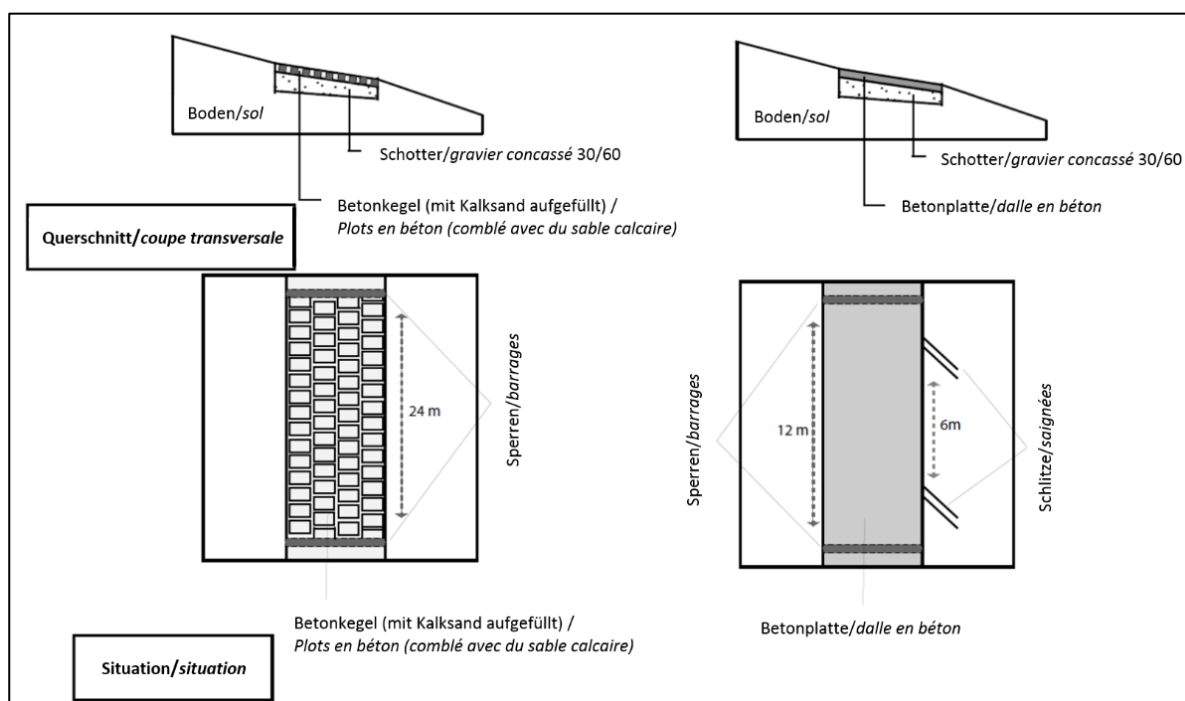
schéma de construction des chemins en plots de béton (a) et en dalles de béton (b)
